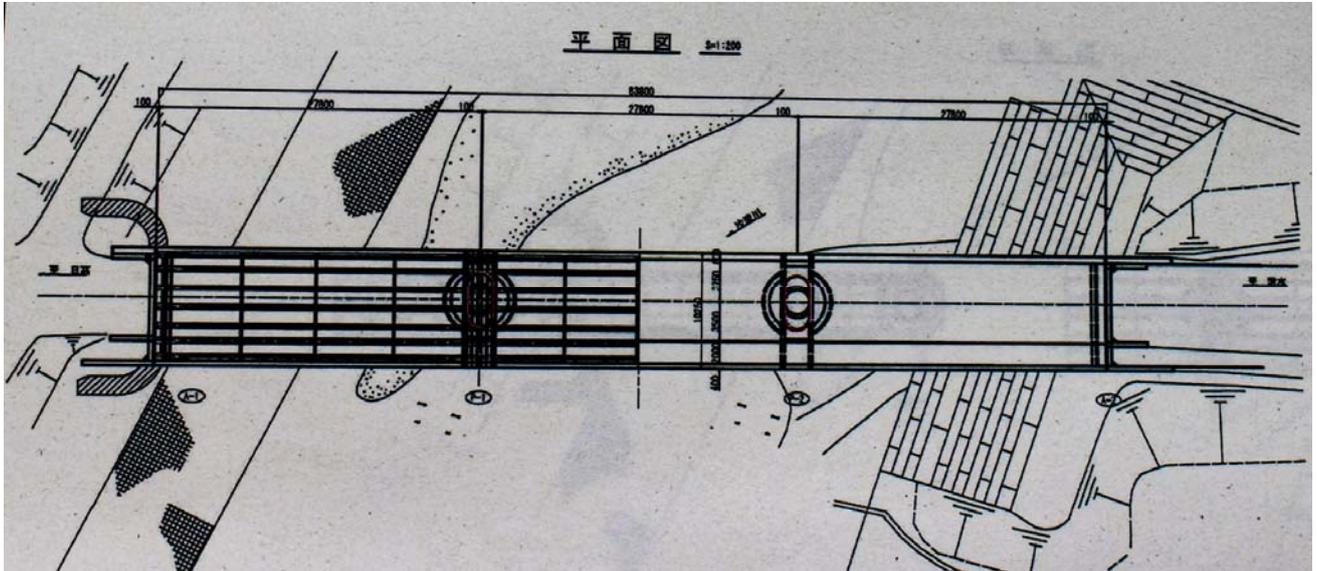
千呂露橋 平面図 (図は平成 25 年度耐震補強設計業務より)
